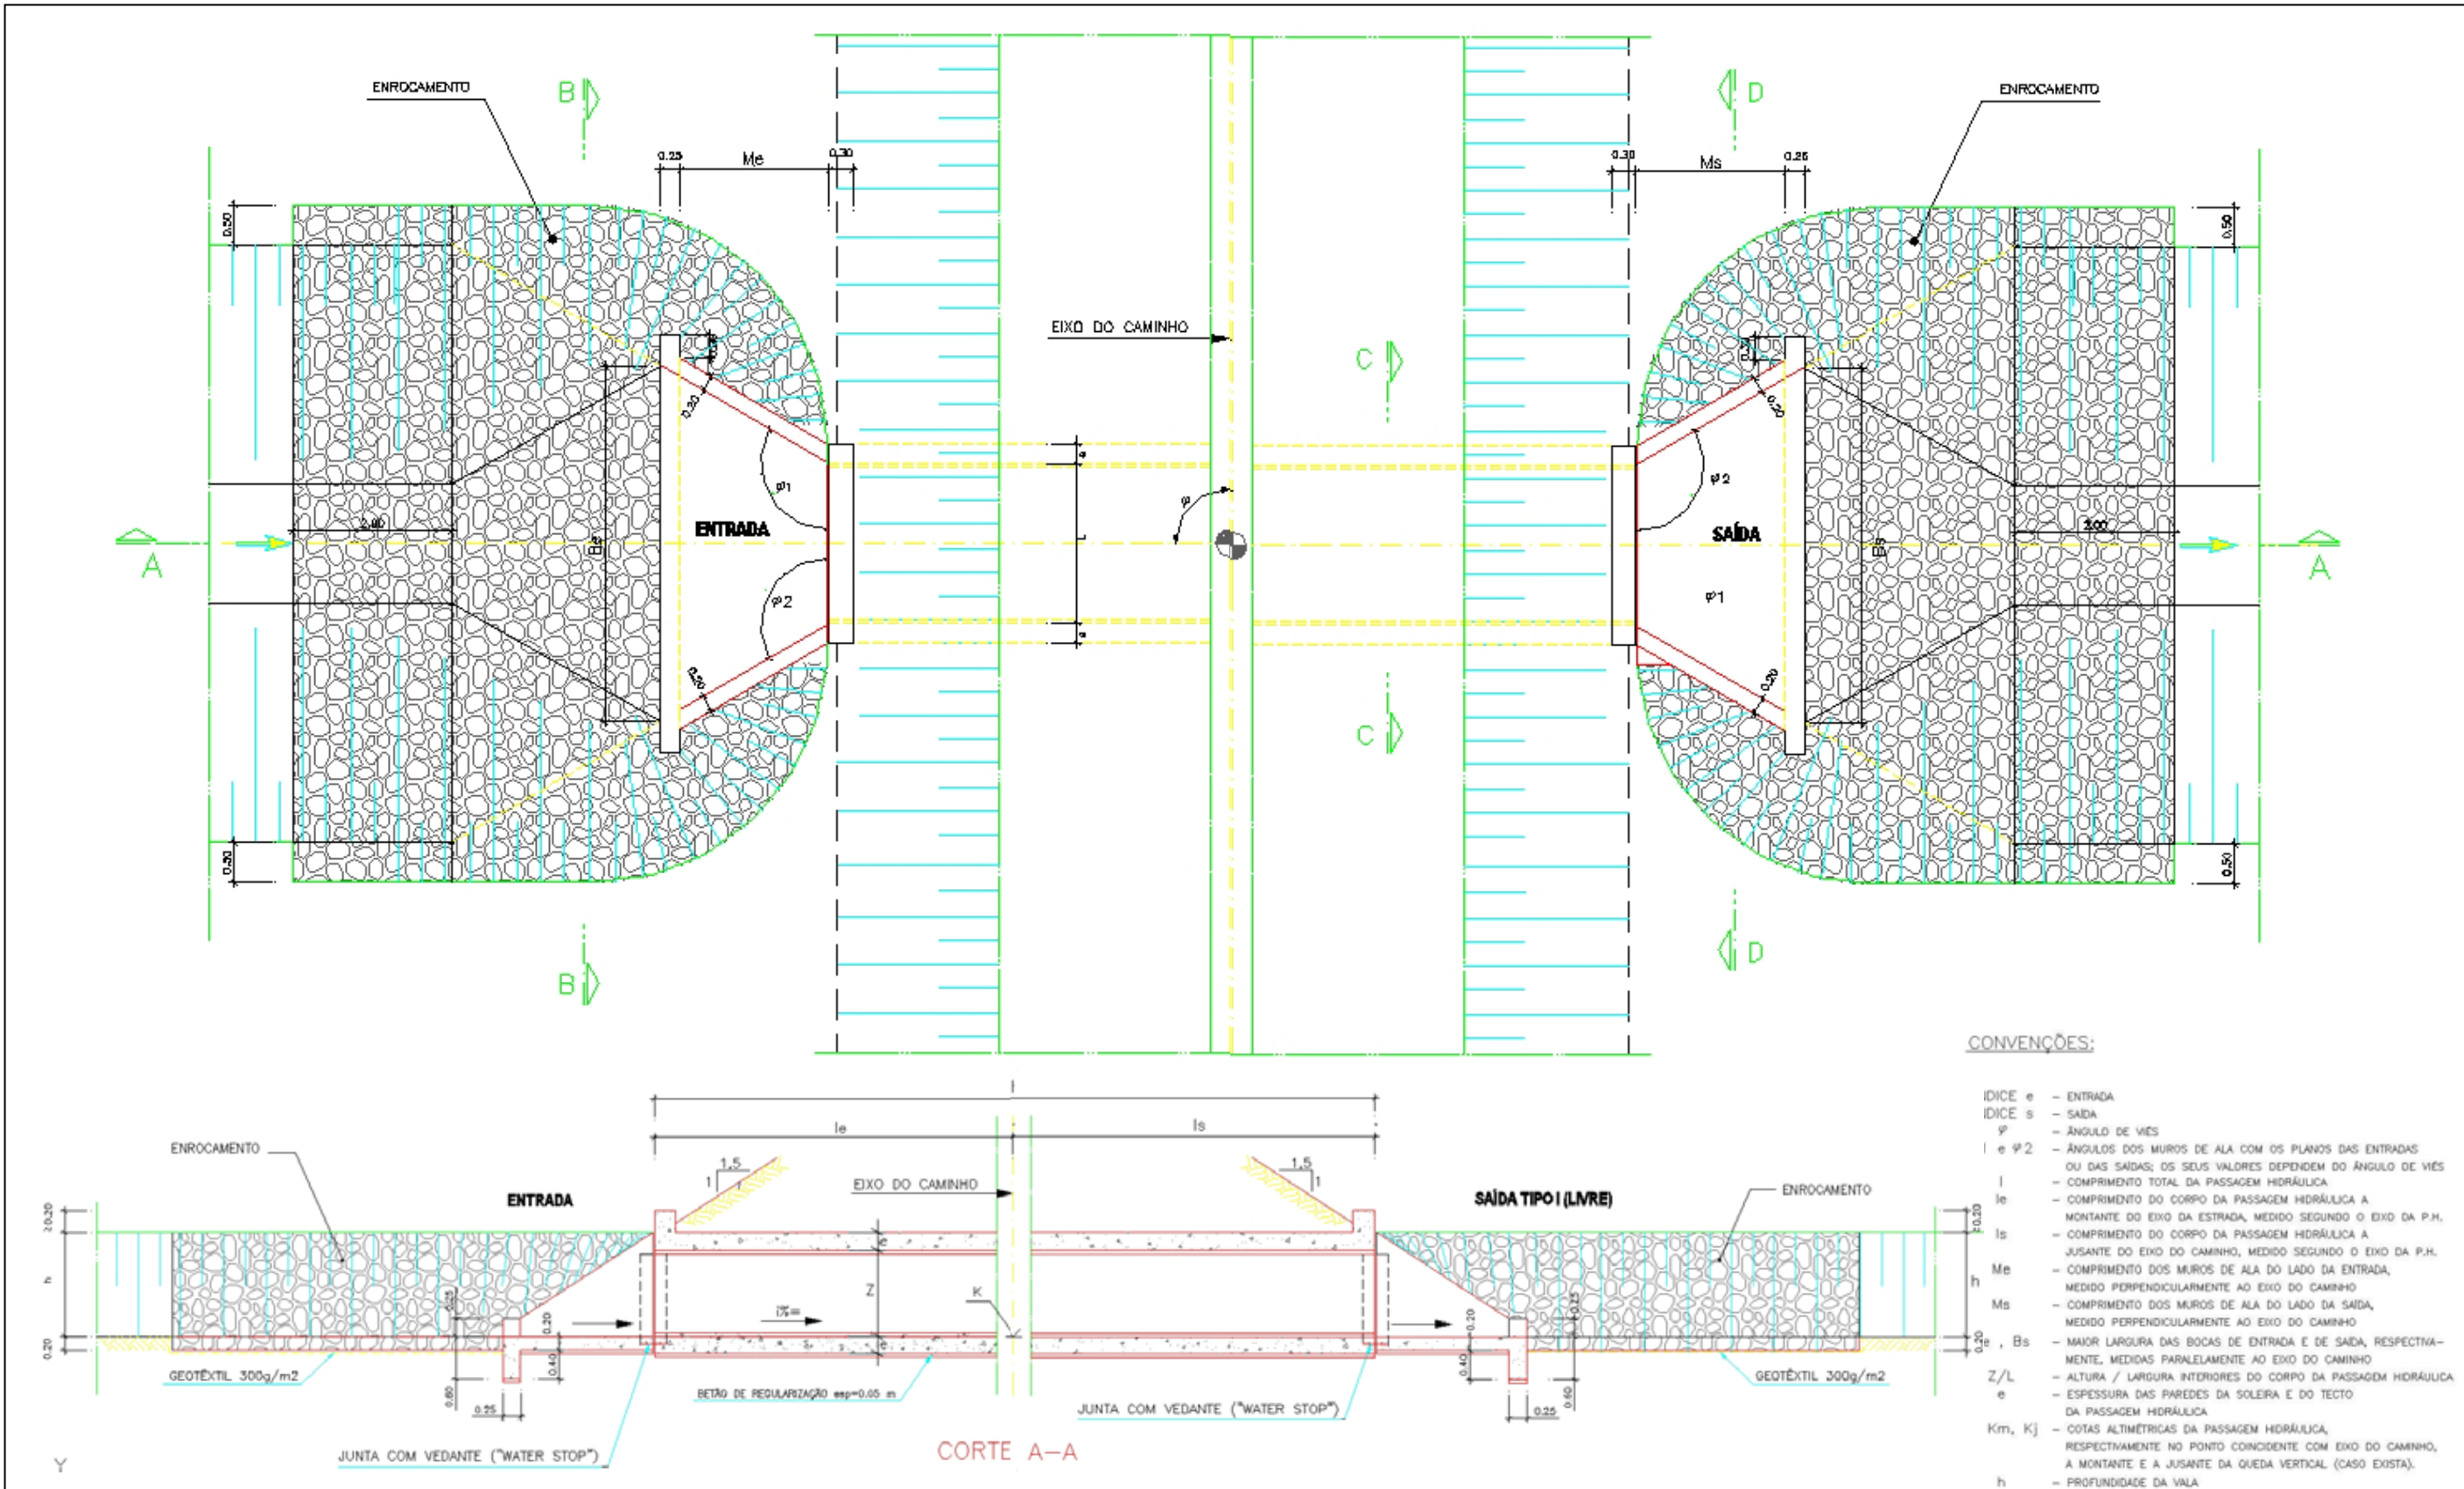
Planta e perfil transversal tipo de passagem hidráulica rectangular prevista construir.
